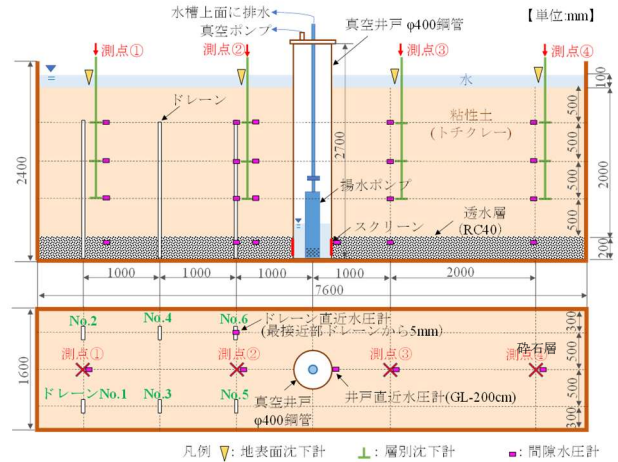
大規模実験土槽断面図(上)・平面図(下)
